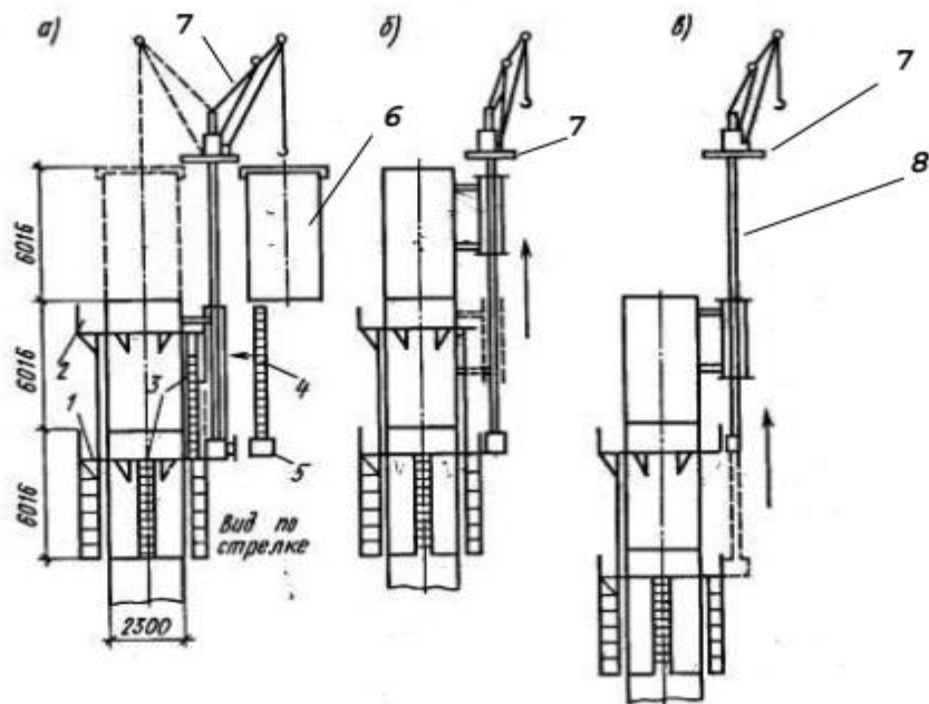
Схема монтажу щогли методом нарощування: а – монтаж секції радіощогли; б – перестановка обойми крана; в – перестановка стовбура крана; 1, 2, 5 – площадки; 3, 4 – драбини; 6 – елемент щогли що встановлюється; 7 – самопідйомний кран; 8 – башта крана
